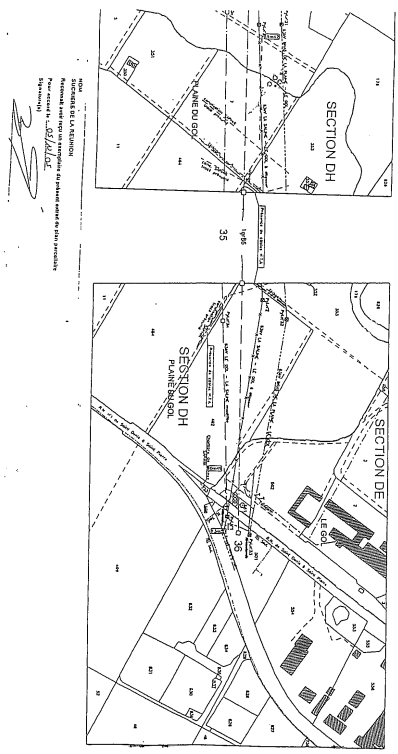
Section de la ligne installée en 1906 (plan) - 1/5000
